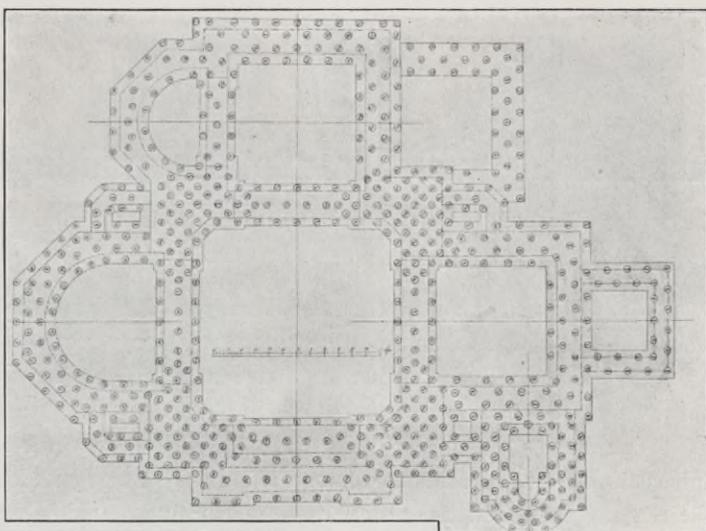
Grundriß der Pfahlgründung einer griechischen Kirche in Kiew.
